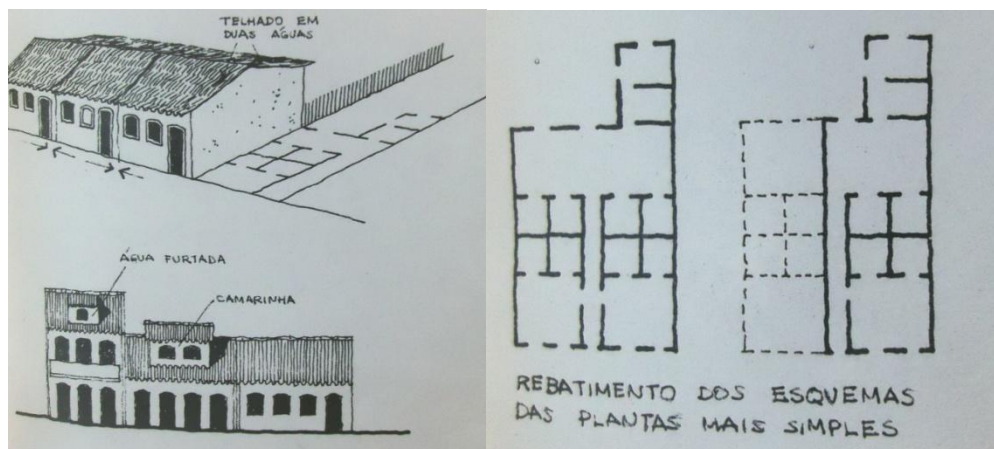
Tipos da casas construídas na colonização. Figura 4 – Planta de casas coloniais.
